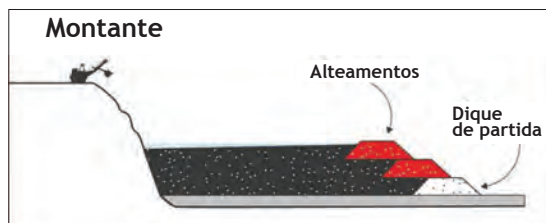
Estrutura de uma barragem a montante (Fonte: Politize, 2019).
